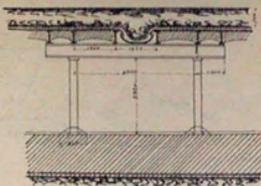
Ferrovia elevata e sotterranea di Berlino. Sezione longitudinale del tunnel.
